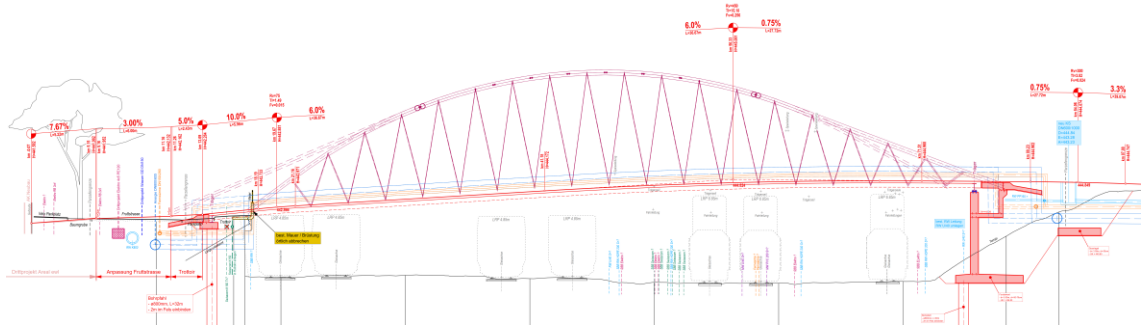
Längsschnitt Brücke inkl. LRP Bahn unterhalb der Brücke
